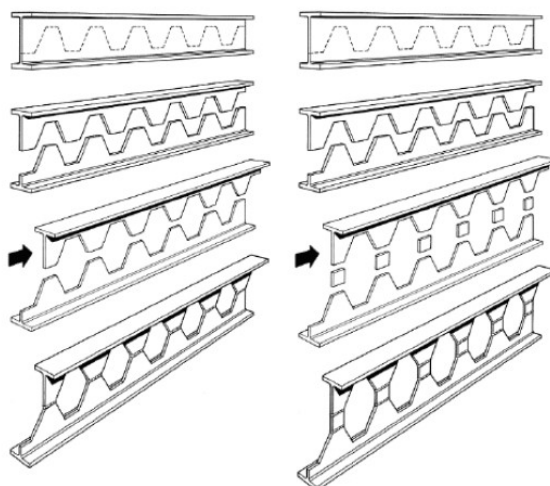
Processo de fabricação de vigas casteladas de aço.
